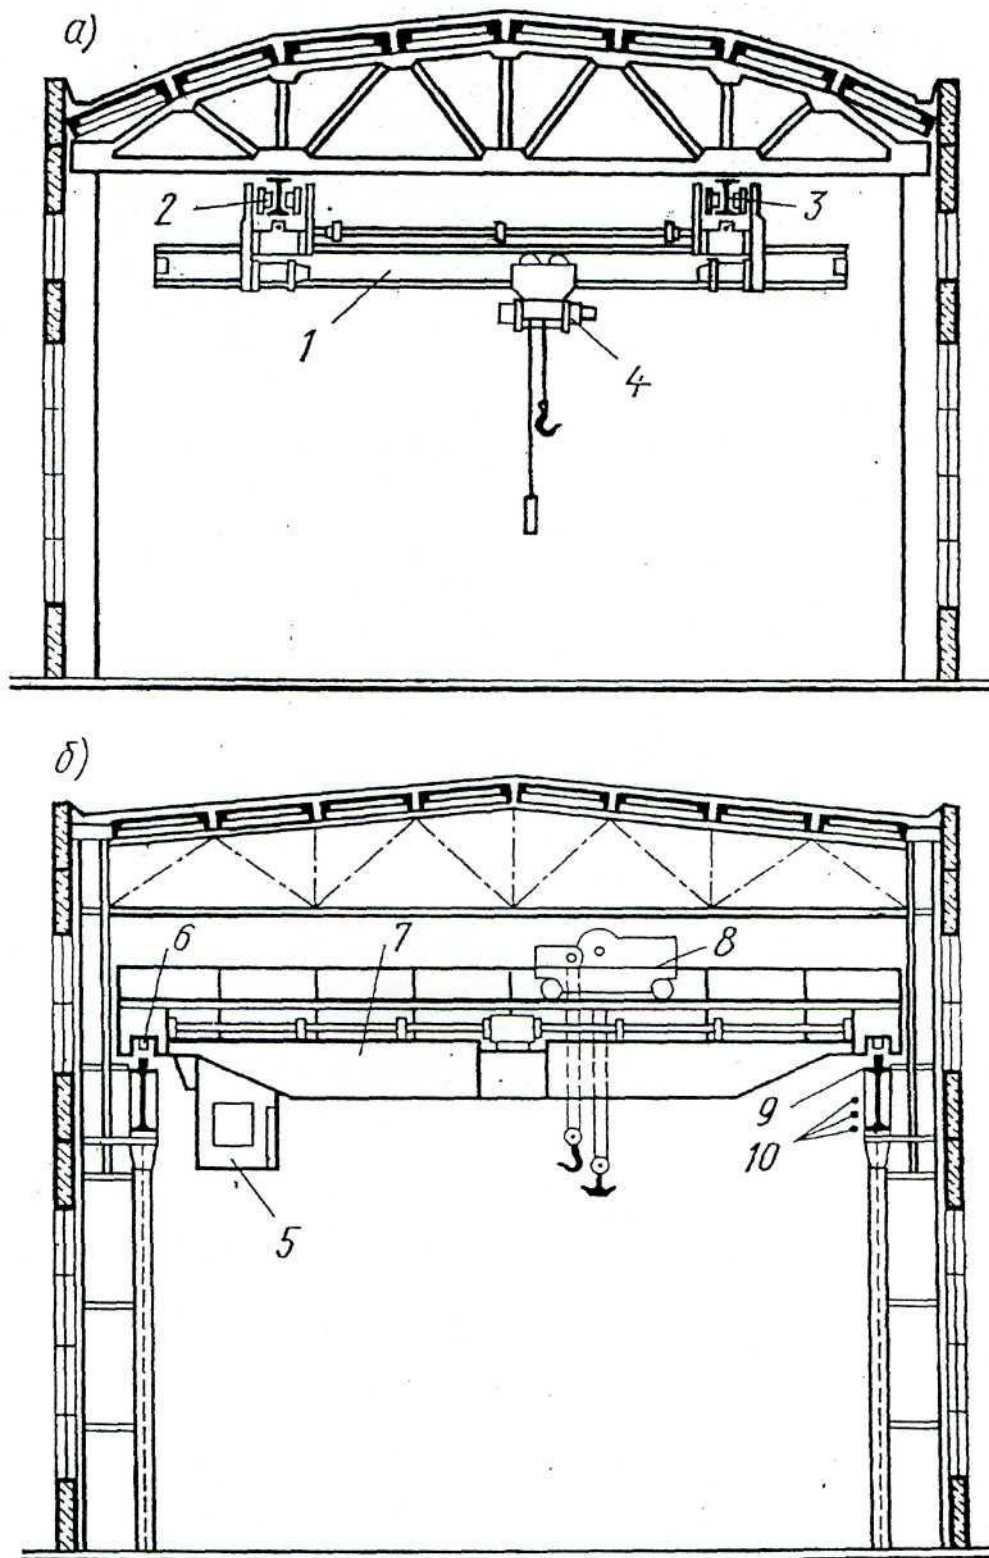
Схемы разрезов зданий с кранами: а - с подвесным краном; б - с мостовым краном; 1- несущая балка; 2 - механизм передвижения; 3 - подвесной путь; 4 - электроталь; 5 - кабина крановщика; 6 - механизм передвижения вдоль кранового пути; 7 - несущий мост; 8 - тележка с грузоподъемным механизмом; 9 - подкрановый путь; 10 - токопровод
